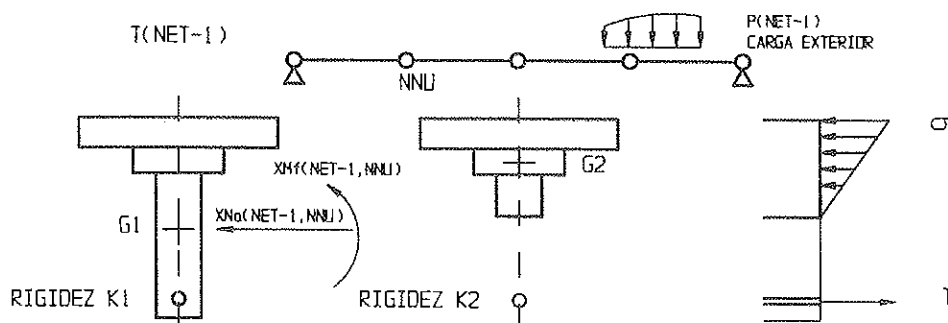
Cálculo instantáneo a nivel sección y estructura.
